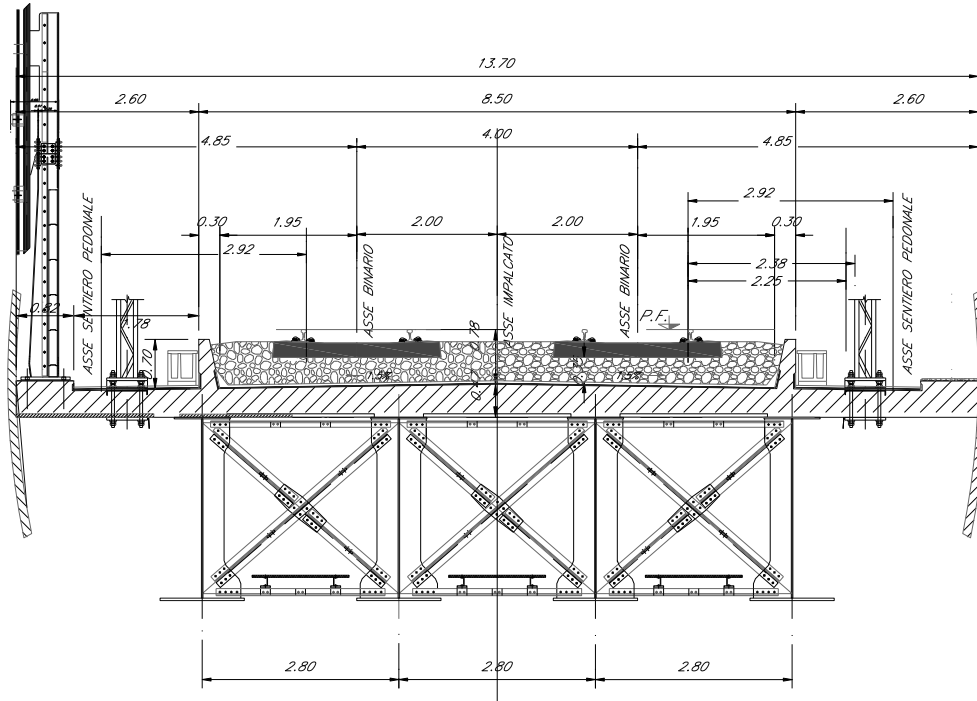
Sezione tipo: Impalcato a struttura mista acciaio calcestruzzo a doppio binario – fino a pila 15
